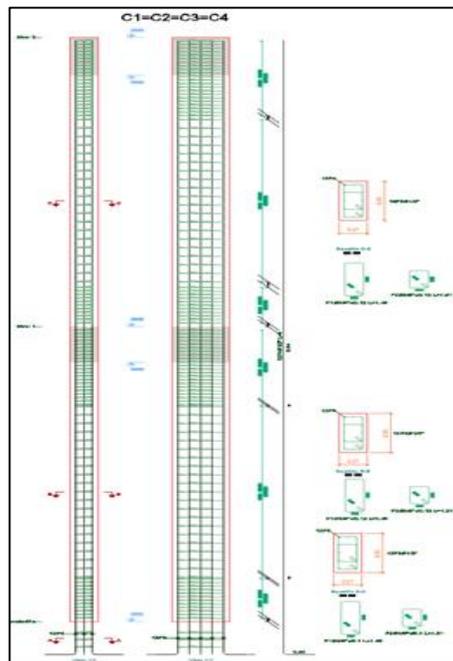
COLUMNAS EN EJE B-B- MODULO I
